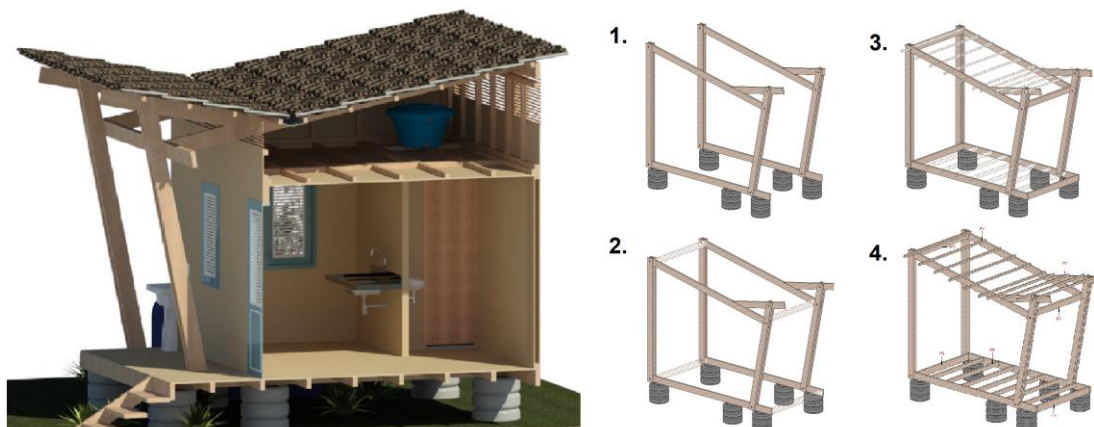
Corte e esquema de montagem da estrutura. Fonte: Elaborado pelos autores.
